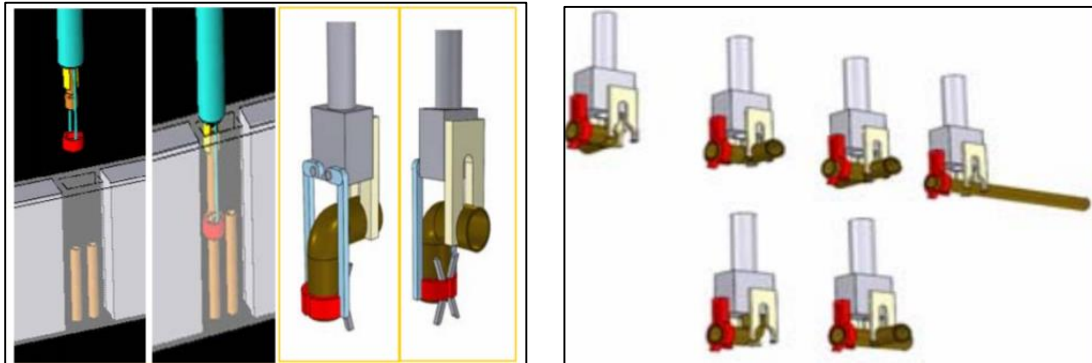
Módulos del sistema de fontanería y sistemas de conexión. Fuente: <http://cort.as/-M57g>
